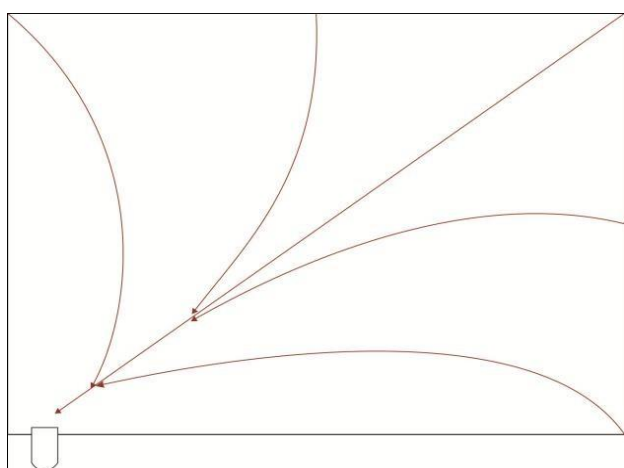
Vista superior de la colocación de la pendiente en losa plan
